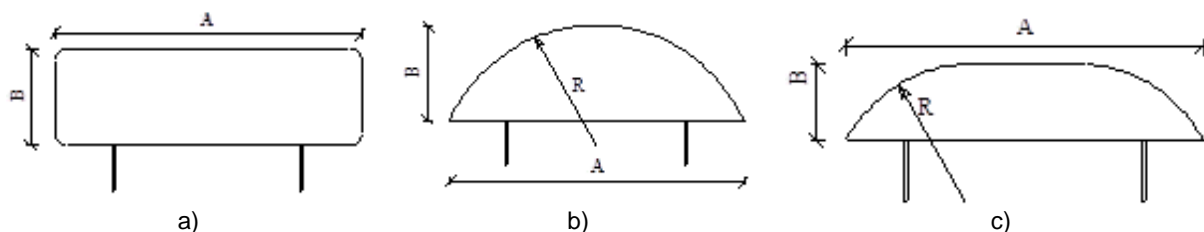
Diferentes tipos de macacos planos (vista esquemática em planta): a) rectangular; b) circular; c) semi-circular.
